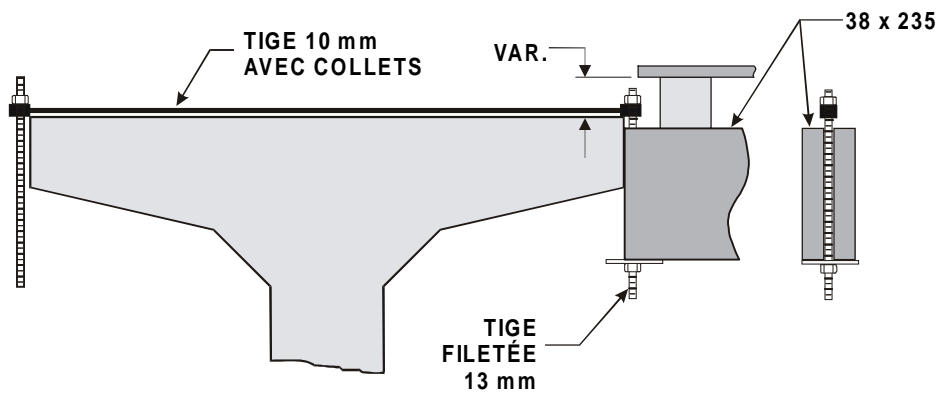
Construction du coffrage du tablier entre les poutres sur la travée 4 (photo DES.159)
